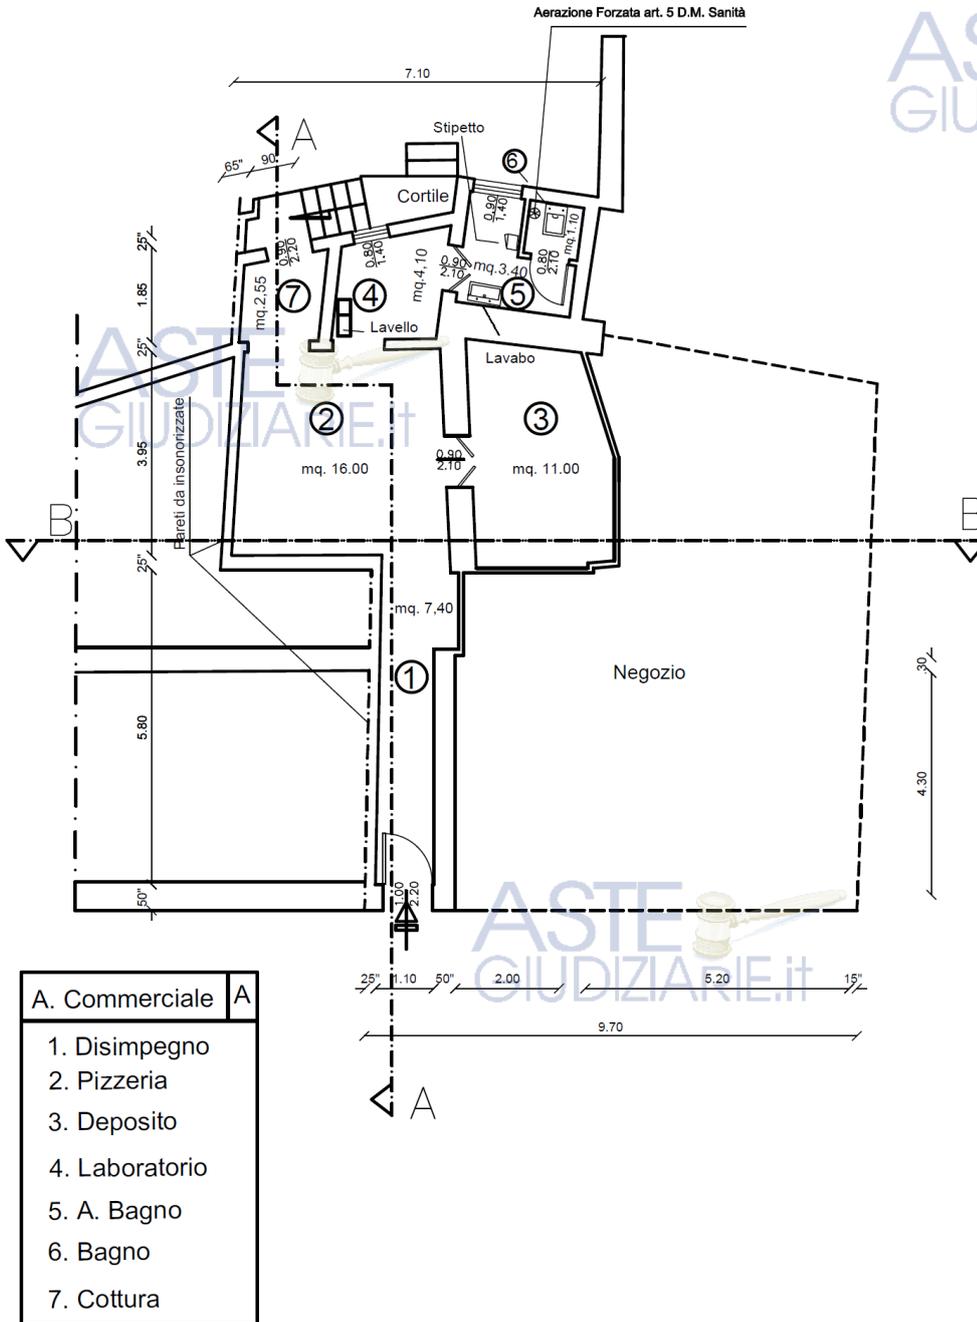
Estratto della planimetria relativa al sub. 2 - Ultimo atto edilizio depositato presso il comune - (vedasi allegato n. 6)
